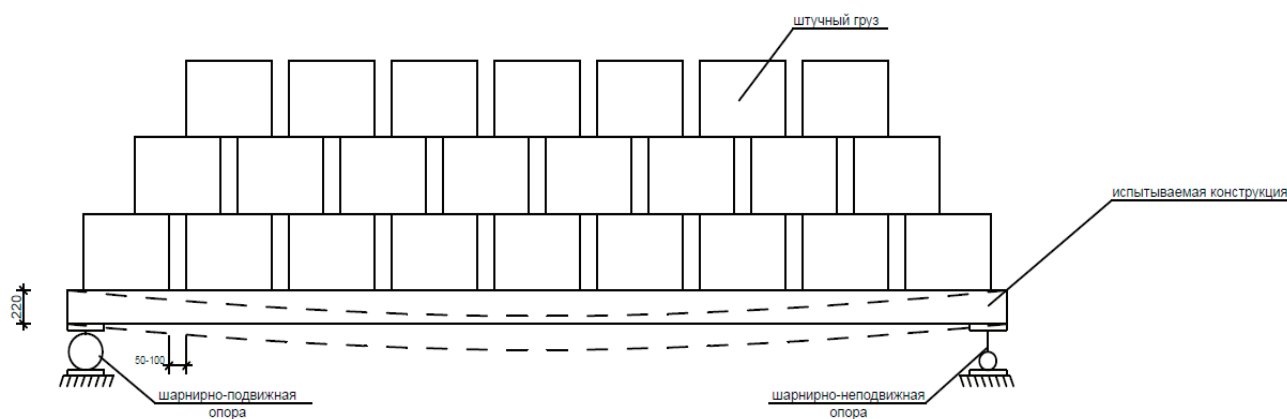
Схема нагружения многпустотной плиты перекрытия, изготовленной на линии безопалубочного формования
